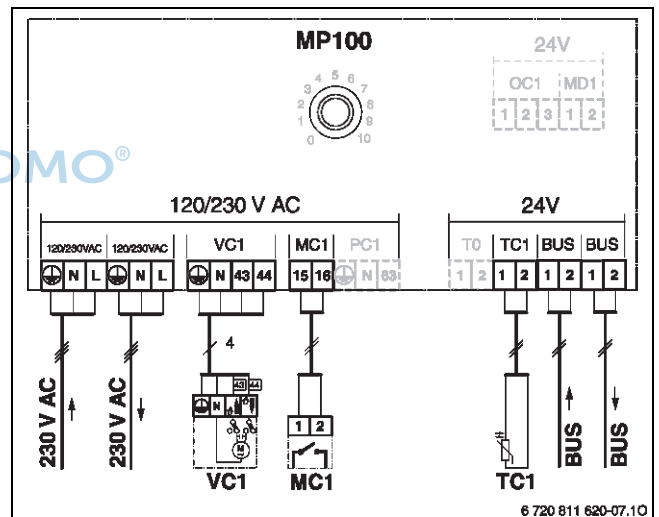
Elektrische Verdrahtung einer Schwimmbadanlage
